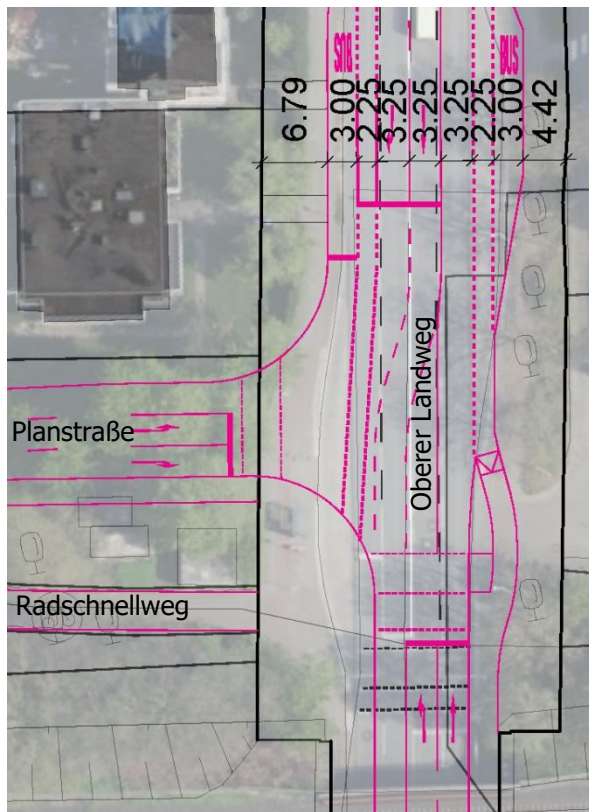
Entwurf des Anschlussknotenpunktes Oberer Landweg/ Planstraße mit separater Führung des Radschnellwegs
